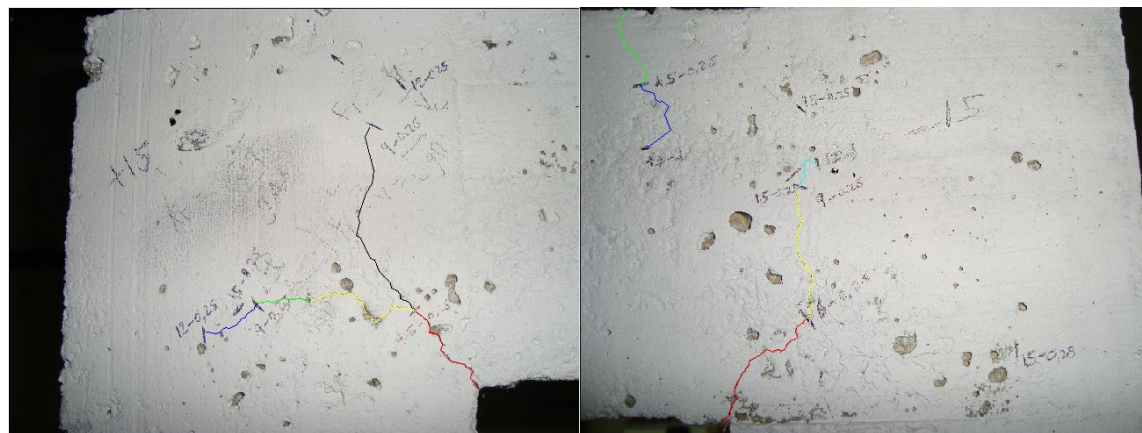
Determinación de la longitud de fisuras para el pórtico 3
